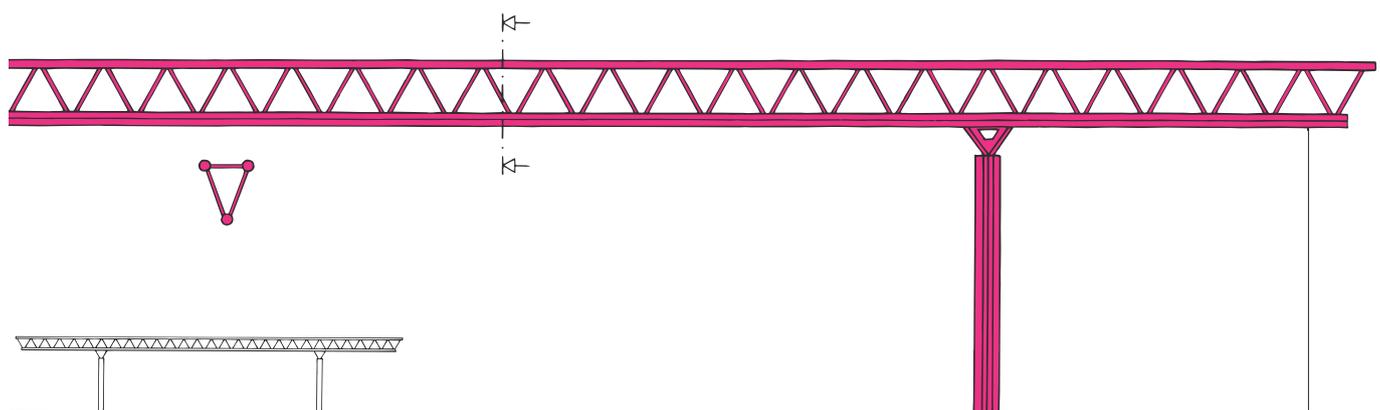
Binder mit Kragarmen als dreigurtiger Fachwerkträger, Spannweite 28,80 m, Gerüstbau-Halle, Echting
